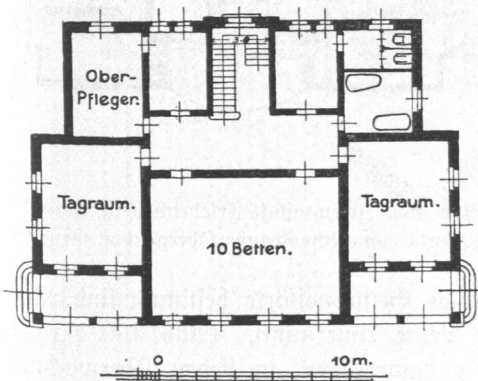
Irrenanstalt Friedrichsberg, Männerhaus für Genesende, Erdgesch. Grundriß.
